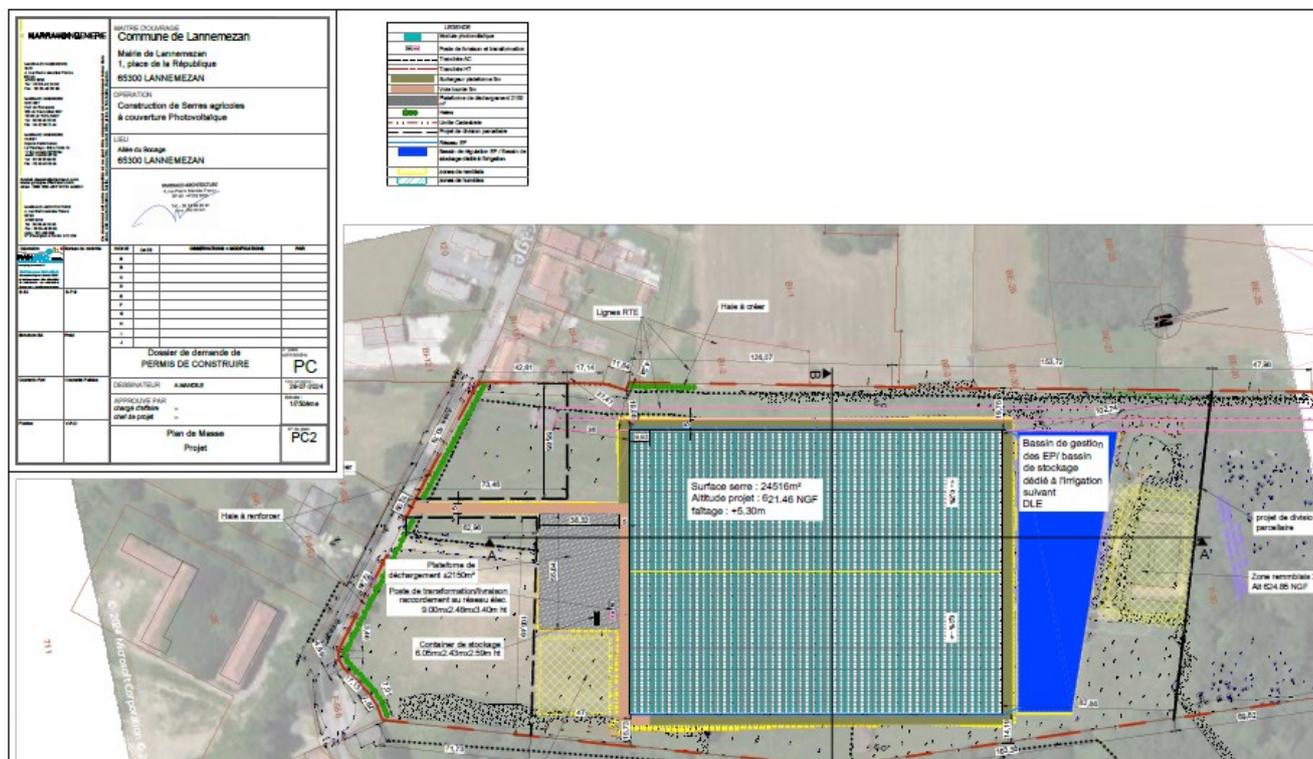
Plan de masse du projet (source : dossier permis de construire)
